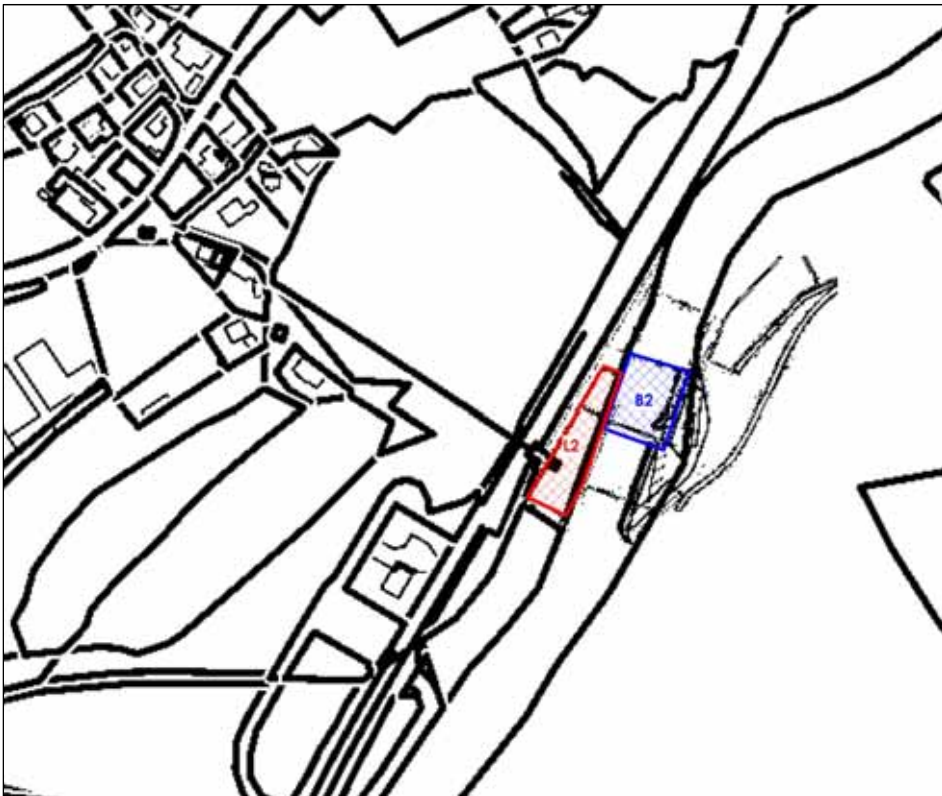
Lageplan mit Darstellung der Schallquellen für den Baustellenbetrieb V3
